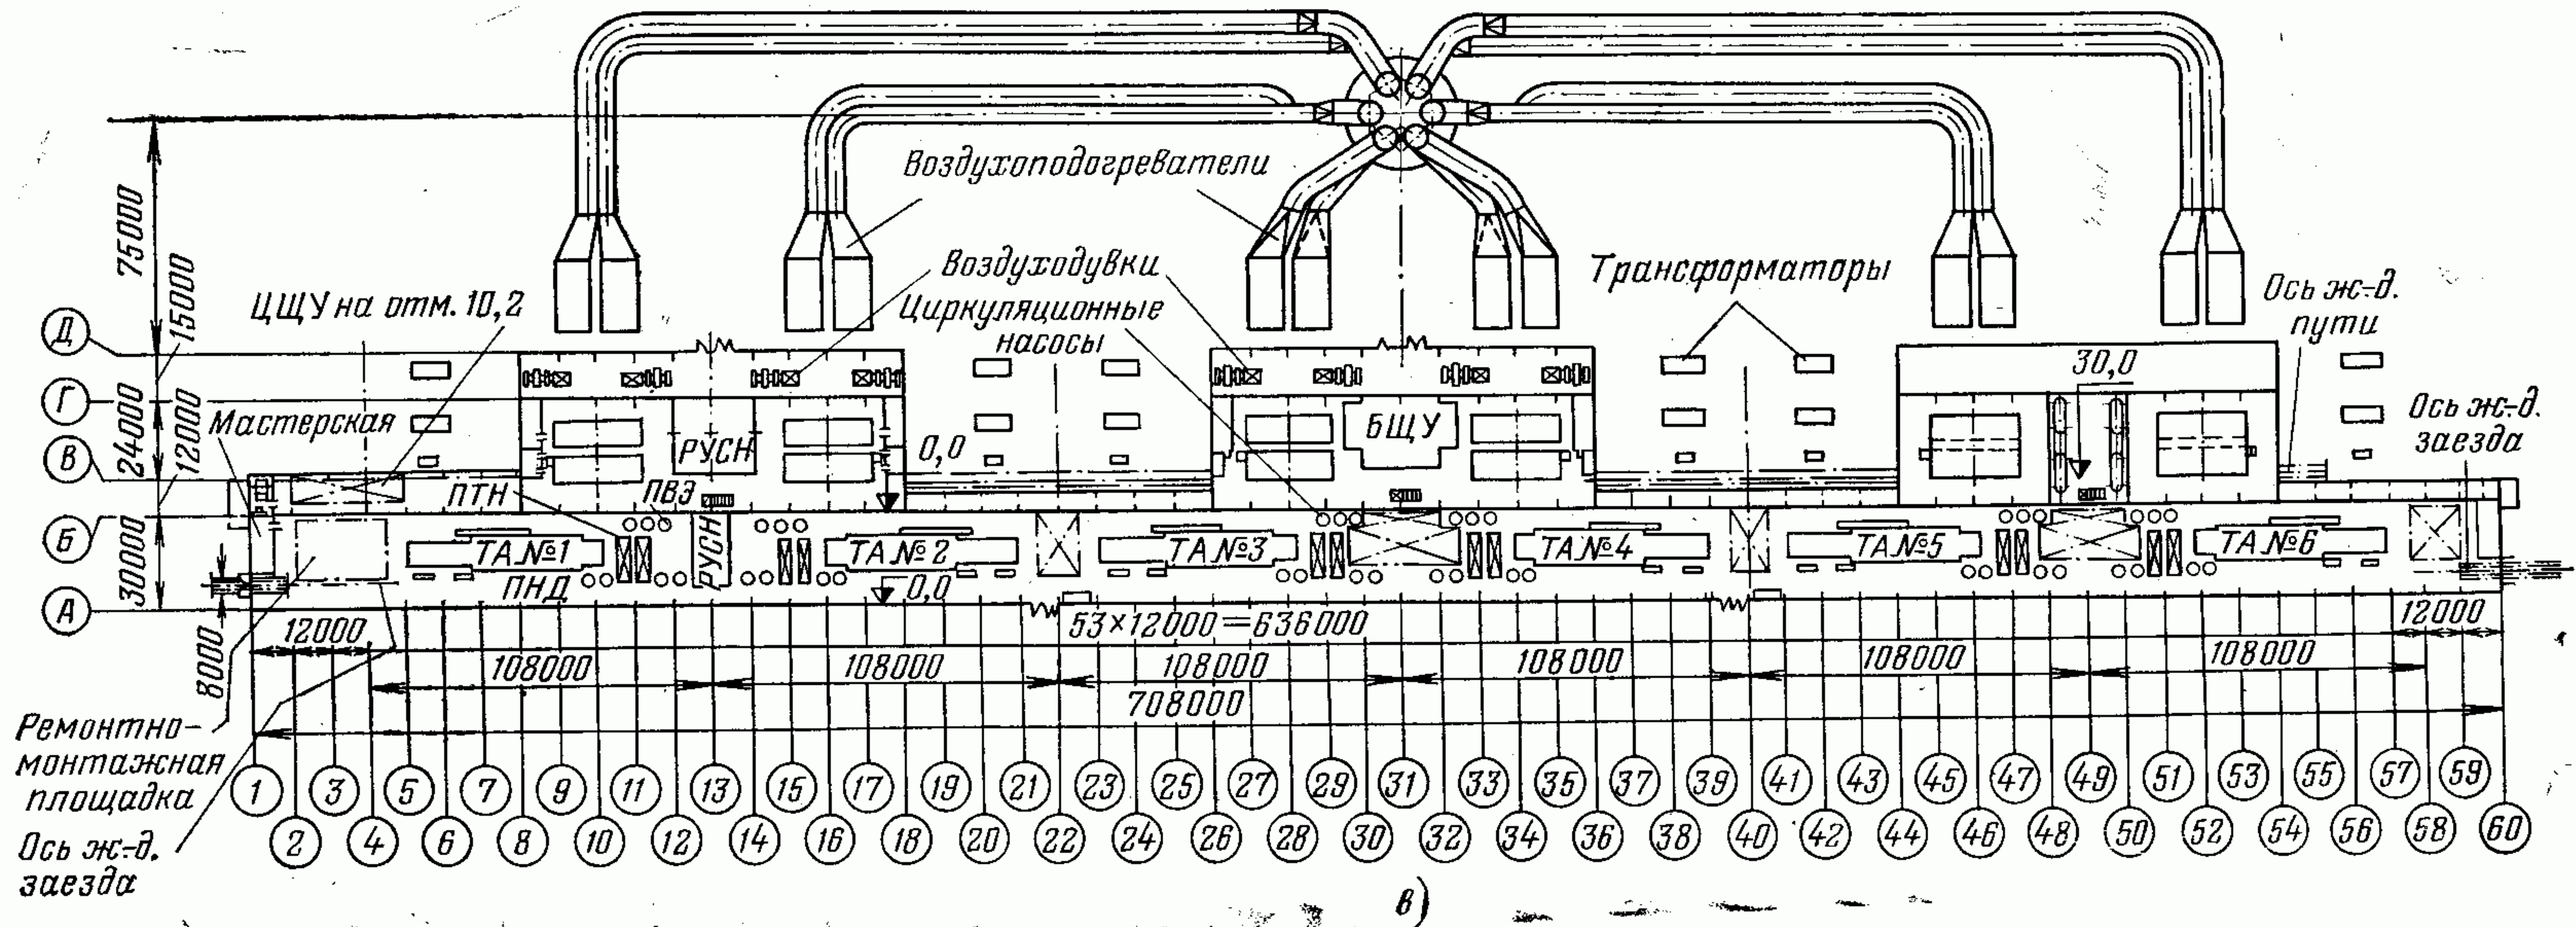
Компонировка главного корпуса газомазутной электростанции с энергоблоками 800 МВт («зубчатая» компоновка с продольным расположением турбоагрегатов в машинном зале).
